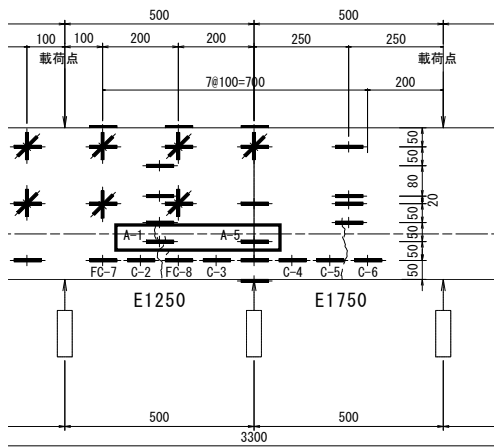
着目したひび割れとひずみゲージ位置
